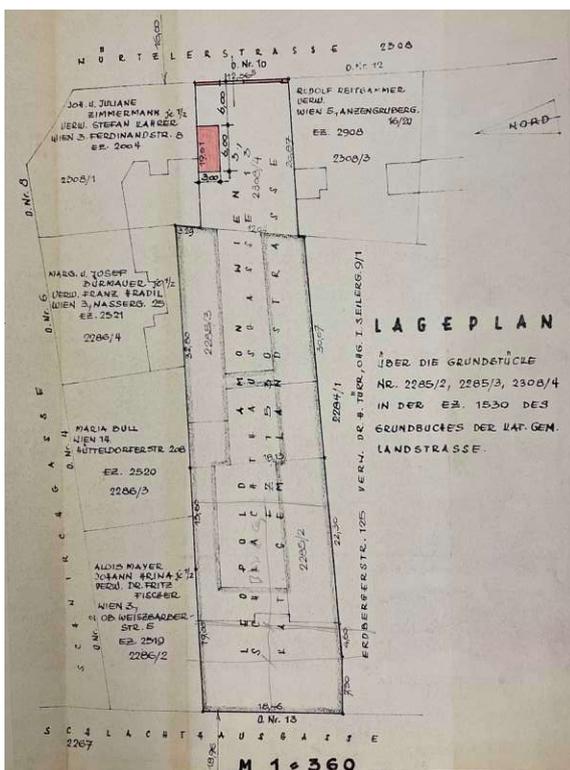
Lageplan gesamtes Grundstück, 1993
